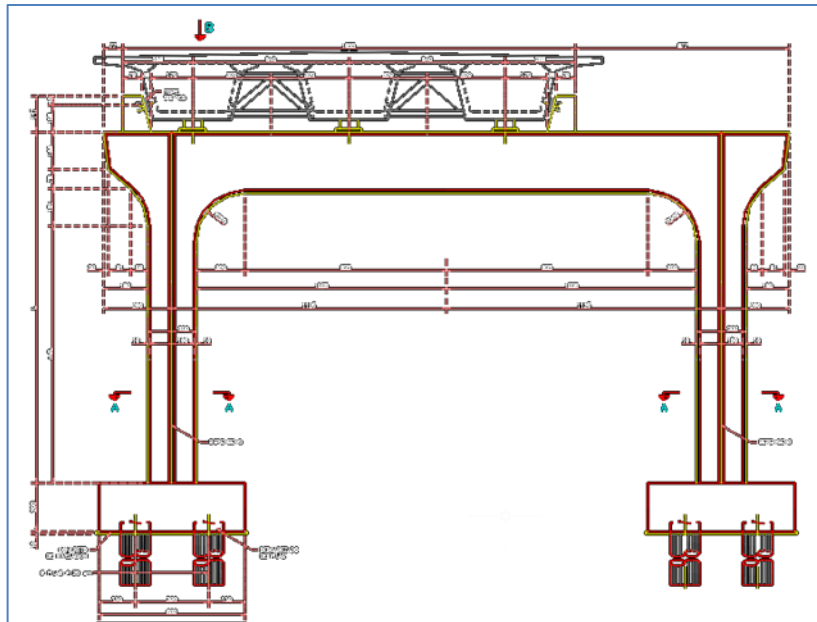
Alzado de pórtico en tramo isostático con 3 vigas.
